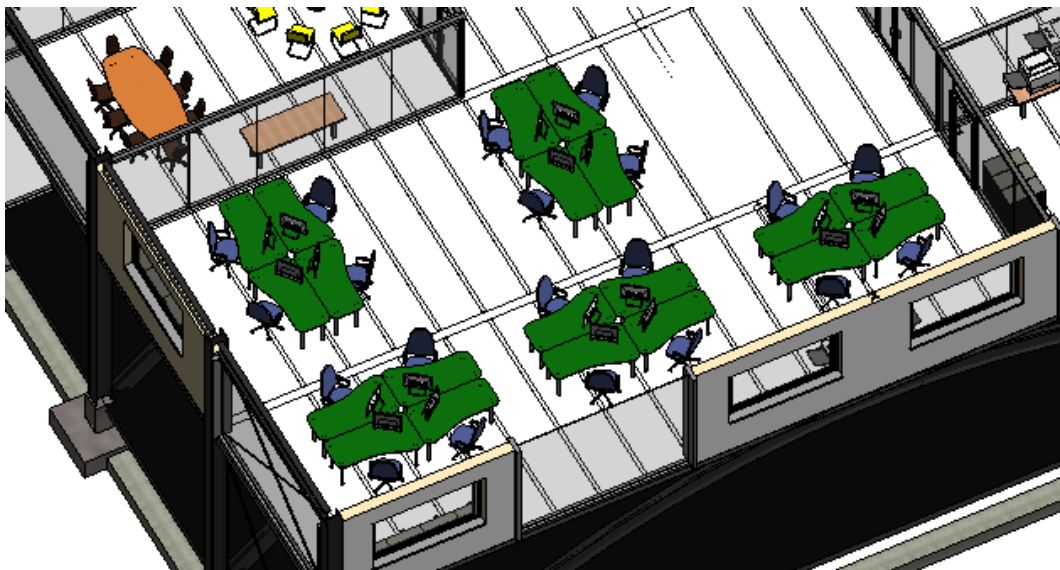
Vista en 3D de la propuesta de distribución de los puestos de trabajo.
